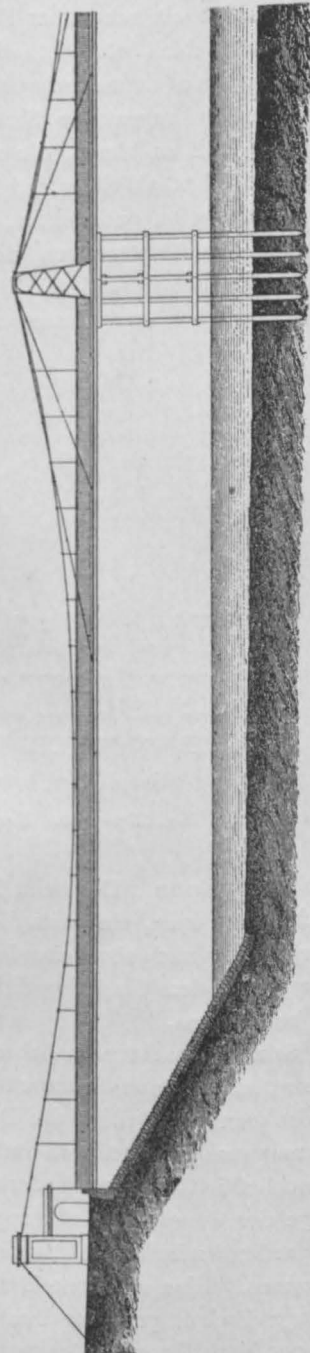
Trinitas-Landungsbrcke in Newhaven bei Edinburgh (nach NAVIER). 1821.
